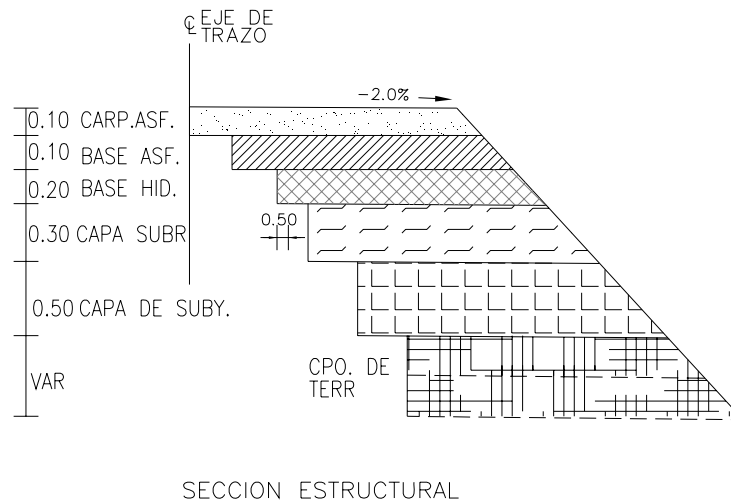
Esquema de la estructura del pavimento contemplada en este proyecto.
